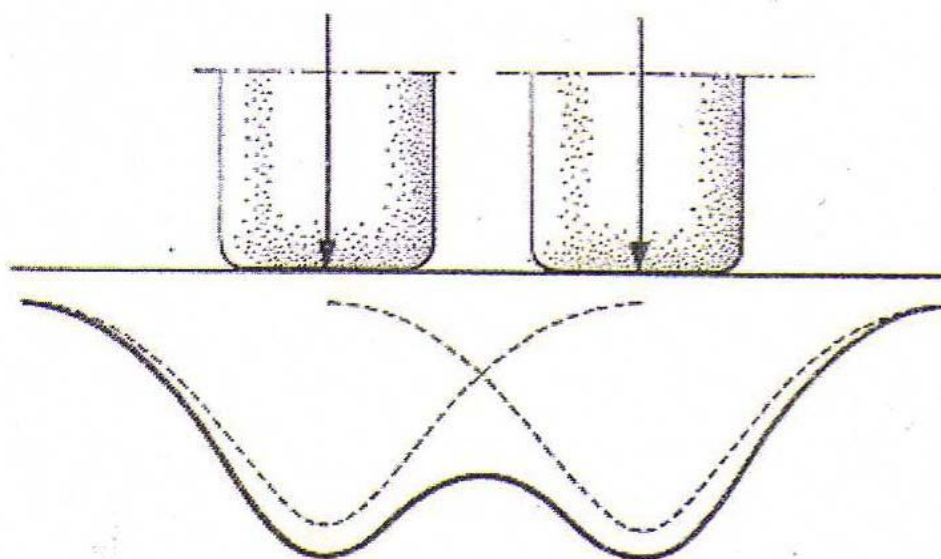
Schema deformativo della pavimentazione per effetto di ruote gemellate (18).
